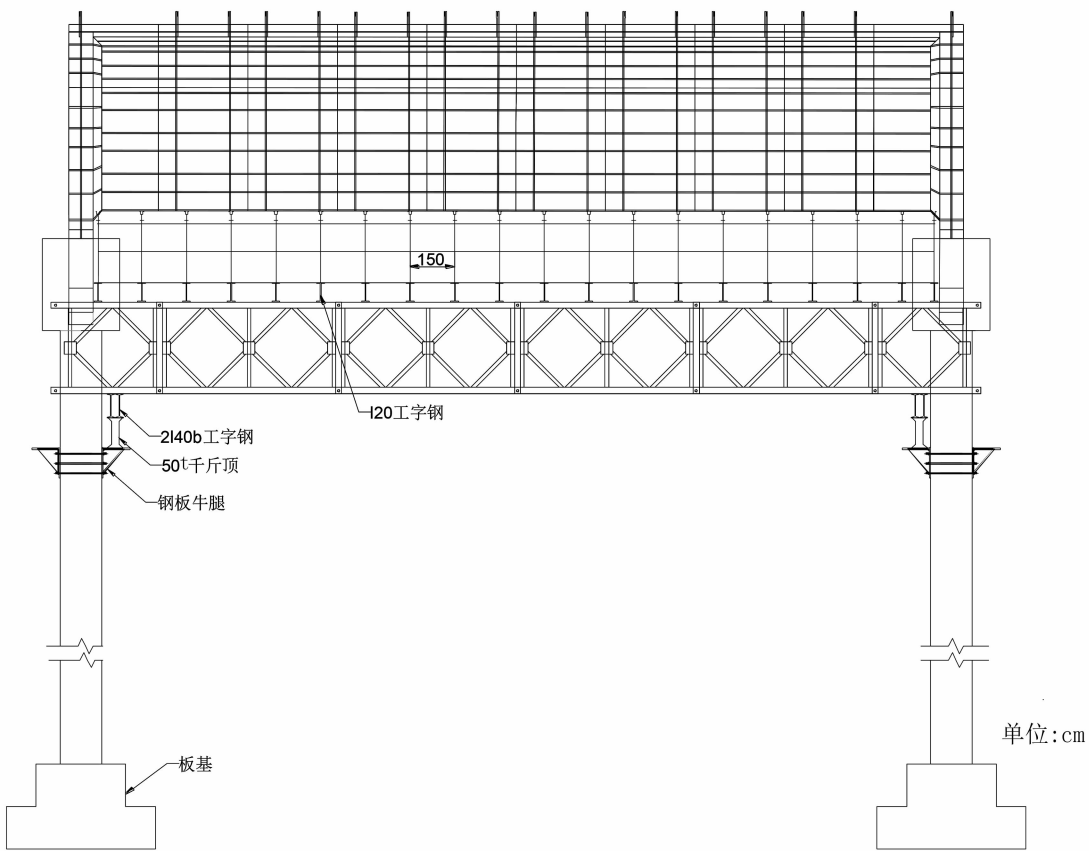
钢板牛腿+贝雷架施工支架纵剖面示意图
